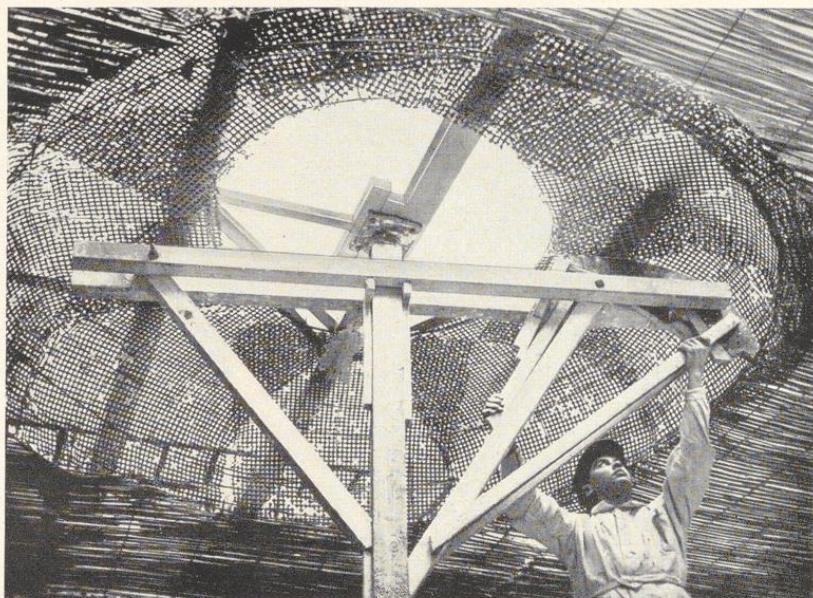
Rundkuppel mit Ziegeldrahtgewebe fertig ausgespannt. Das Ausziehen der Gewölbefläche erfolgt mit einem gut konstruierten drehbaren Flügel
